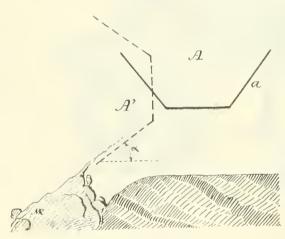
Coupe transversale du coffre d'une brouette du type anglais.
